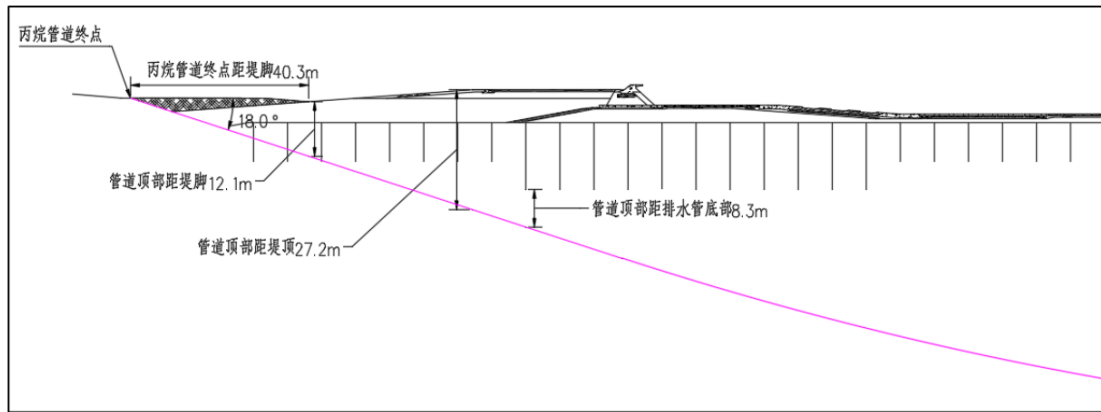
丙烷管道与终点附近大堤纵断面位置示意图
